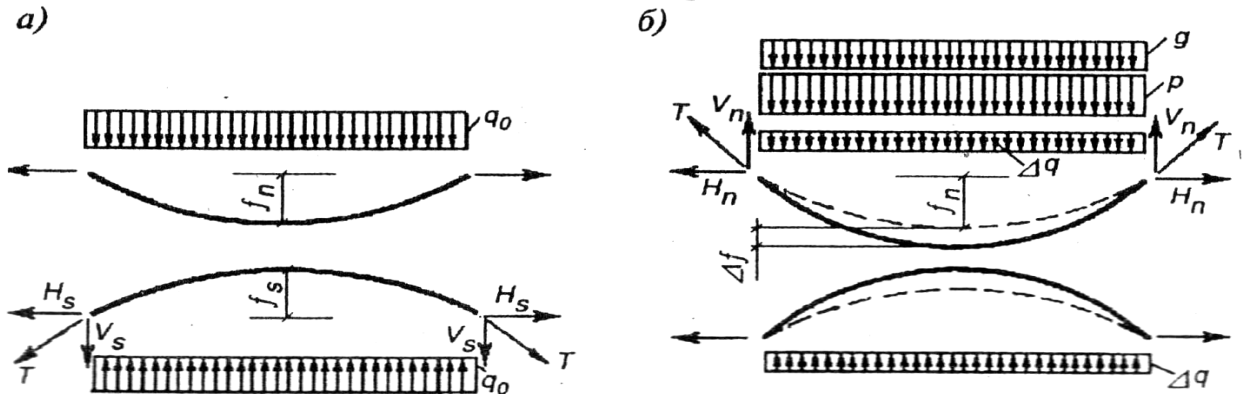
Расчётная схема двухпоясной системы: а – в стадии предварительного напряжения; б – в стадии действия расчётных нагрузок
